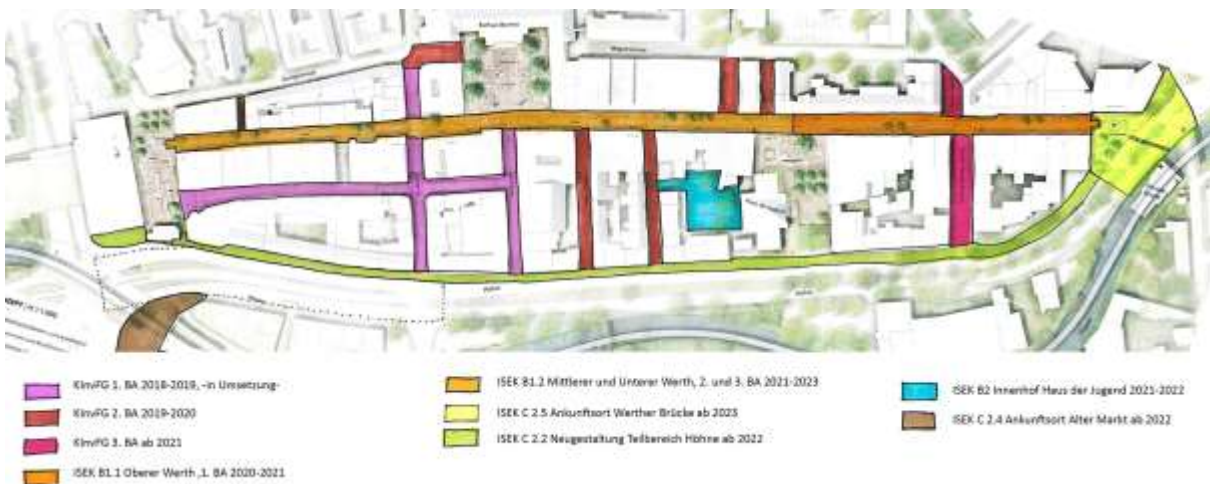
Übersichtsplan zur Umgestaltung der Barmer Innenstadt
